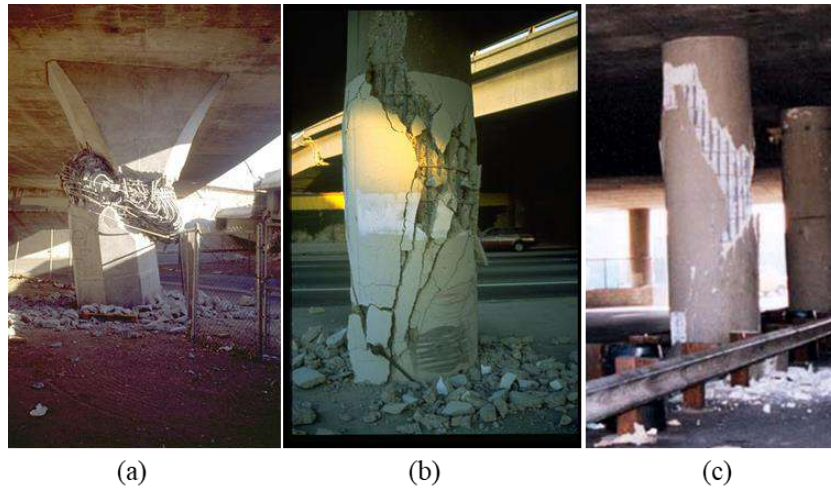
(a) Falla por corte del hormigón. Desintegración del hormigón del núcleo, Puente Mission-Gothic. (b) Falla diagonal de corte con pandeo de armadura longitudinal, Interestatal 10- La Cienaga. (c) Pérdida de hormigón de recubrimiento y fisuración diagonal, Paso a distinto nivel Washington- Autopista Fairfax (NISEE, 2016).
